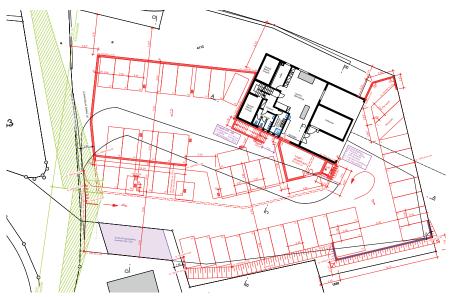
Geplante Situation mit dem neuen Parkdeck und dem süd-westlichen Anbau an die bestehende Talstation (Quelle: Bauspektrum)
